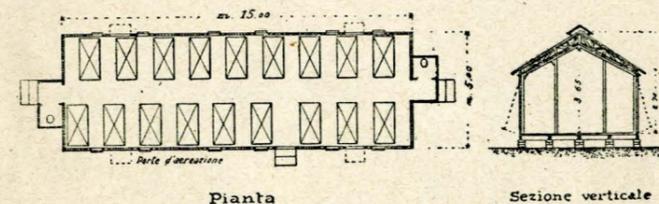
Padiglione Döcker - Pianta e Sezione.
